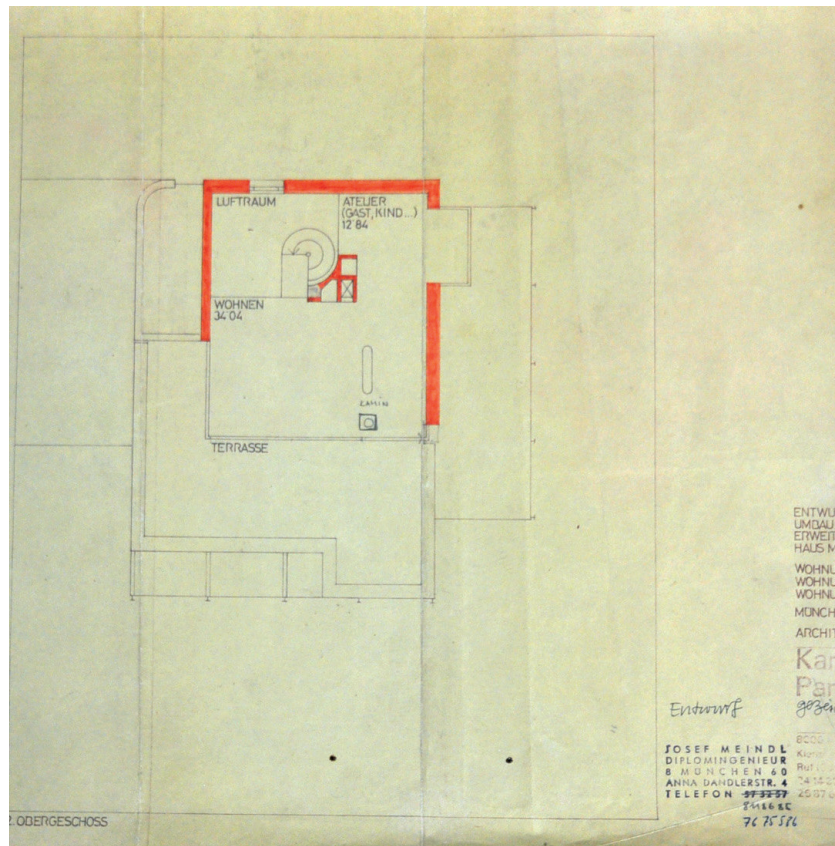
Grundriss 2. Obergeschoß
